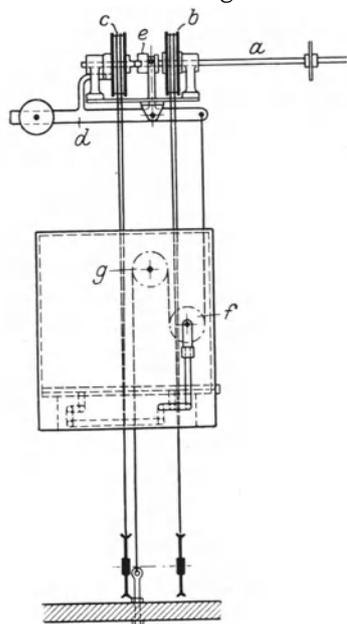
Seilsteuerung für Umstell- aufzüge.
